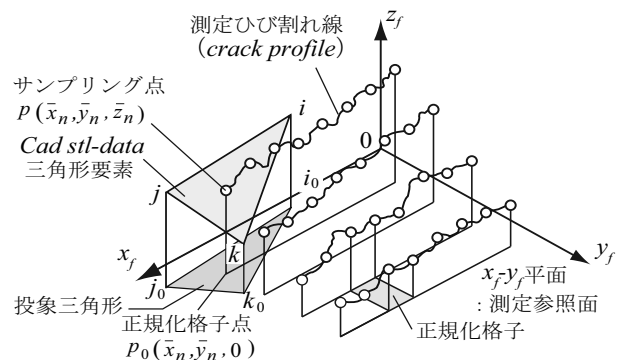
コンクリートひび割れ面のサンプリング点の検出
